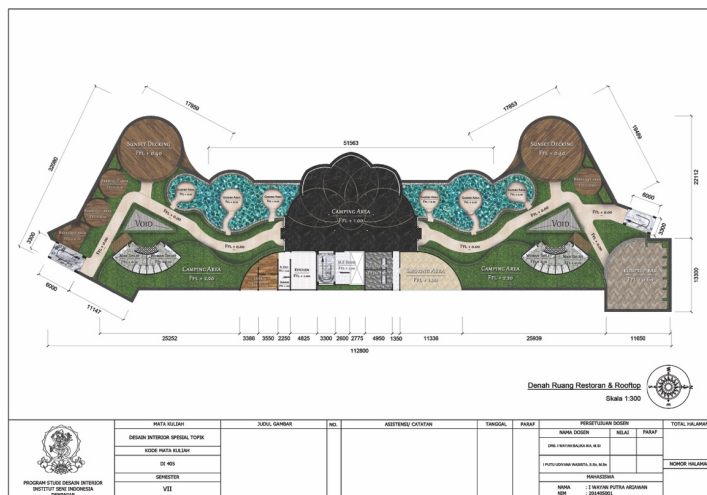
Contoh Pengayaan *Block Plan* Menjadi Layout
